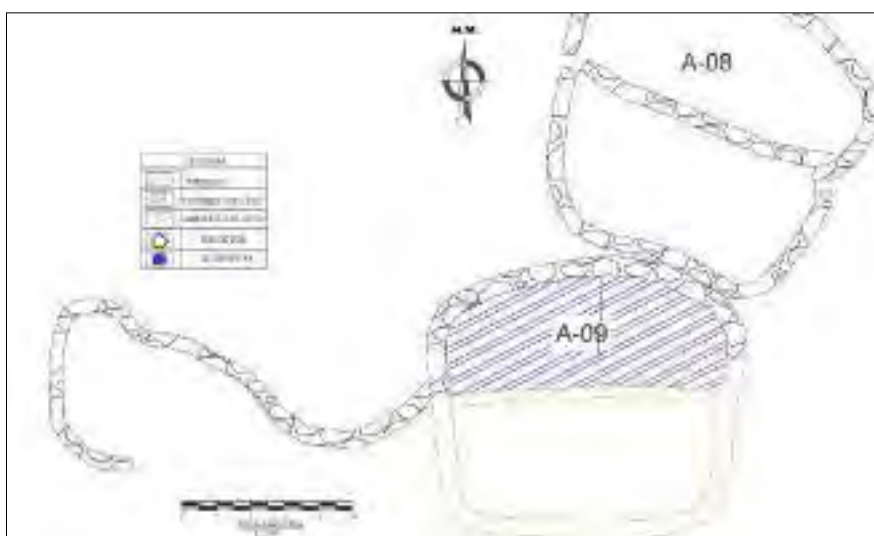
Plano de planta de la estructura A-09, que se proyecta de forma continua con la estructura A-08. Fuente: Propia
